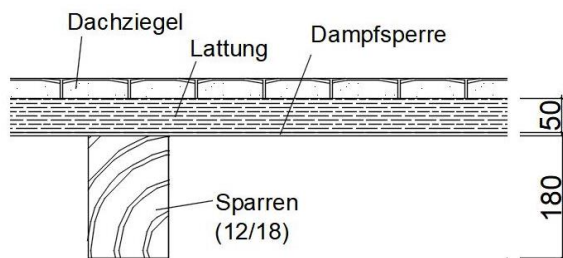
Aufbau Dachkonstruktion ohne Dämmung
